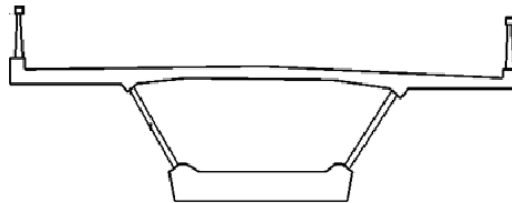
Поперечное сечение пролетного строения моста «Cognac bridge» (Франция)
